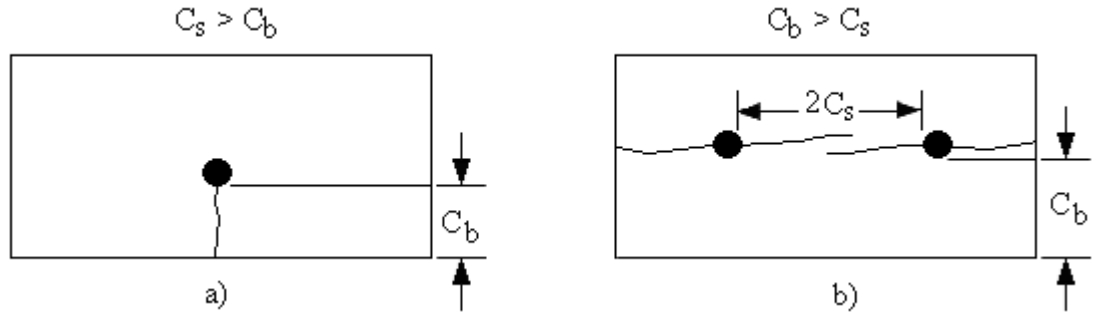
Fissuras de aderência: (a) $C_s > C_b$ e (b) $C_b < C_s$.
